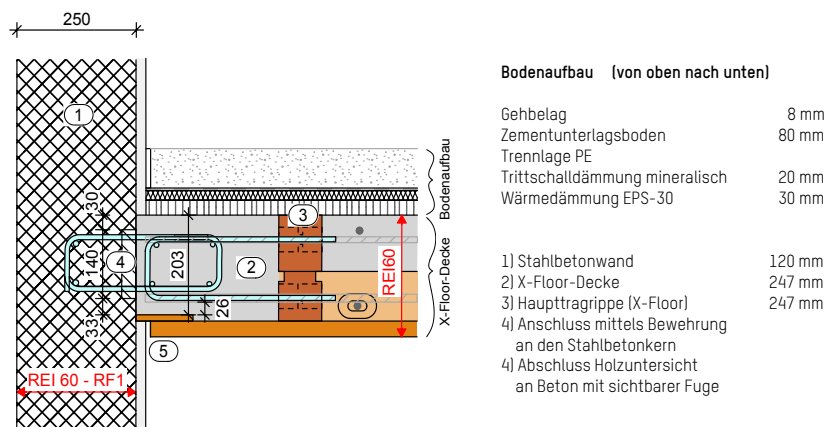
Anschluss der X-Floor-Decke an den Stahlbetonkern
